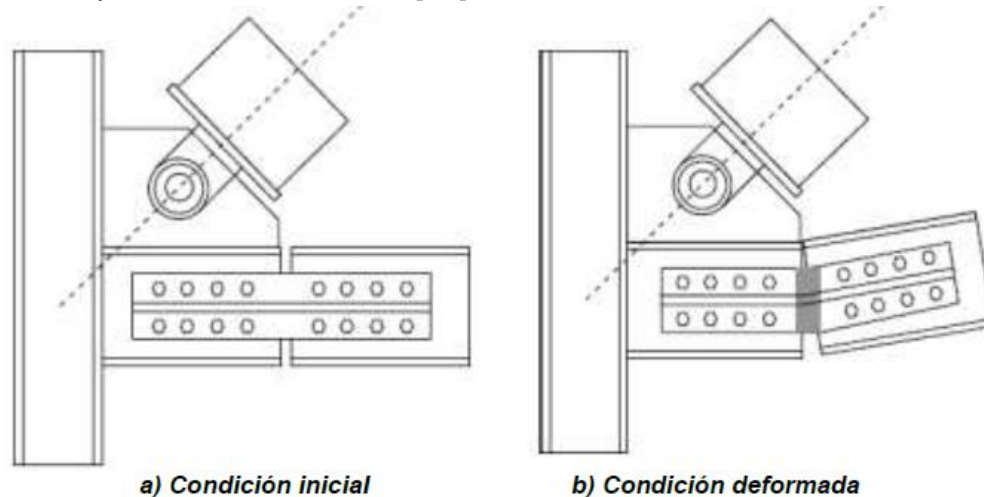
Conexión propuesta de viga-columna-BRB [19].
